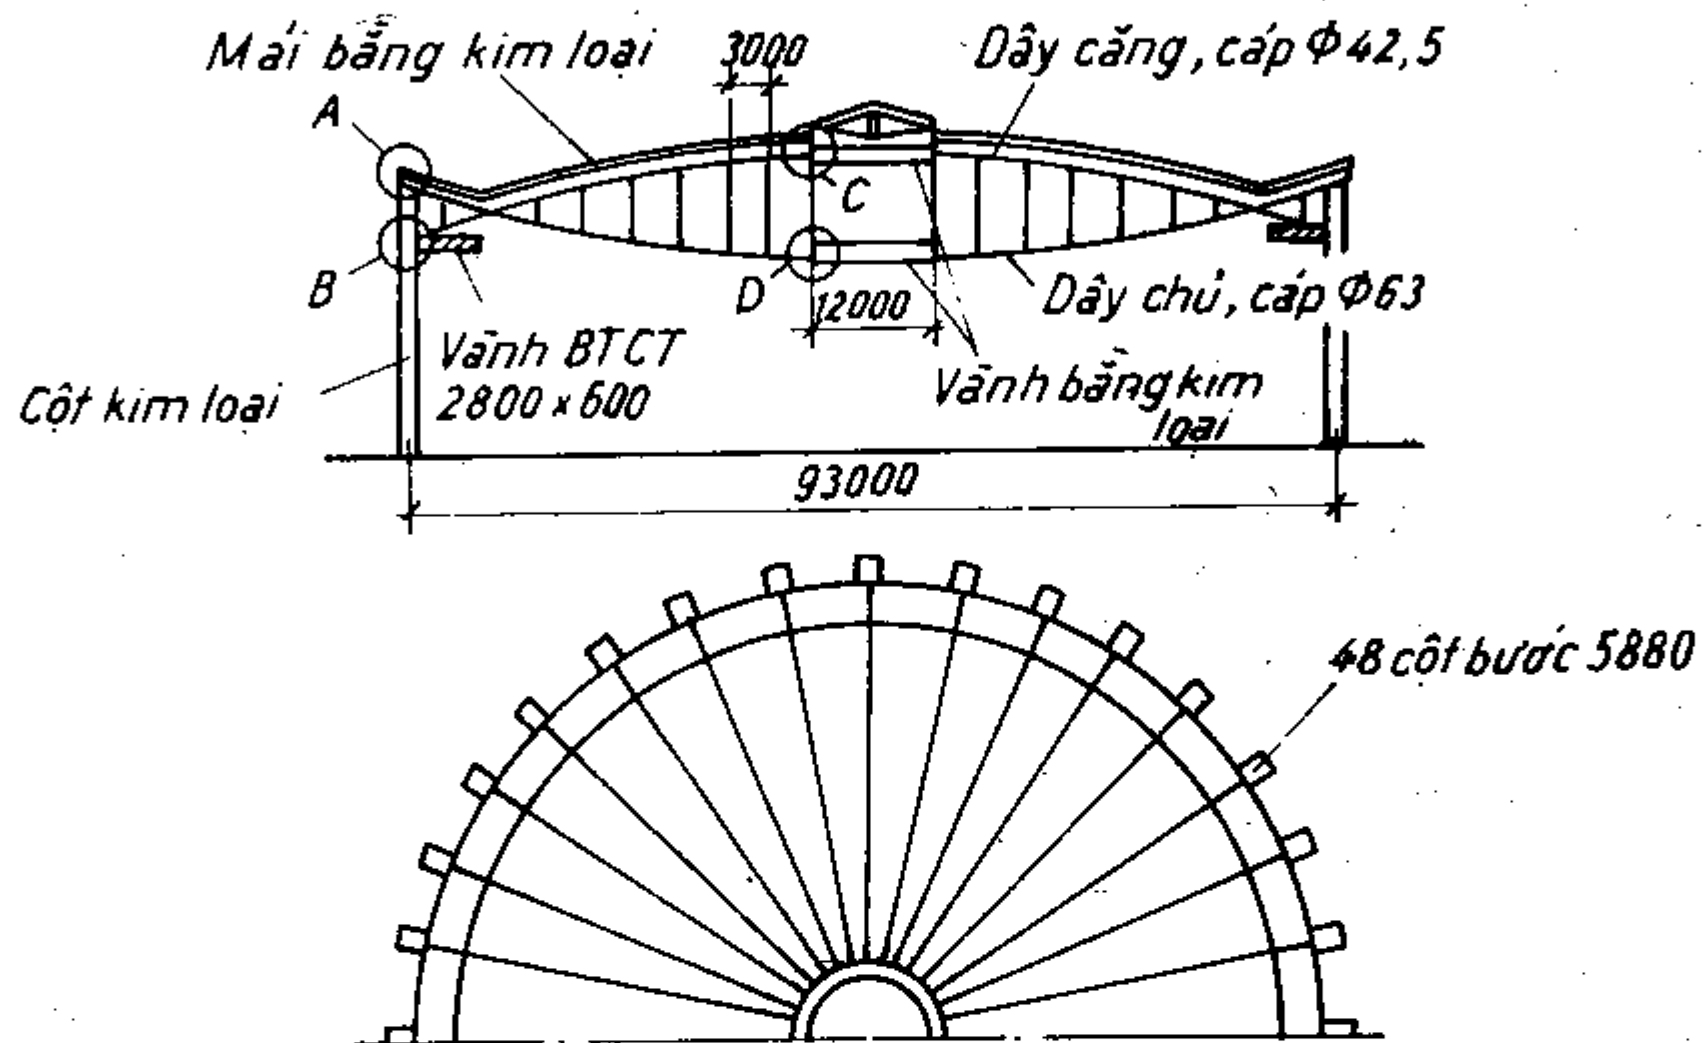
Sơ đồ kết cấu hệ dây hai lớp
